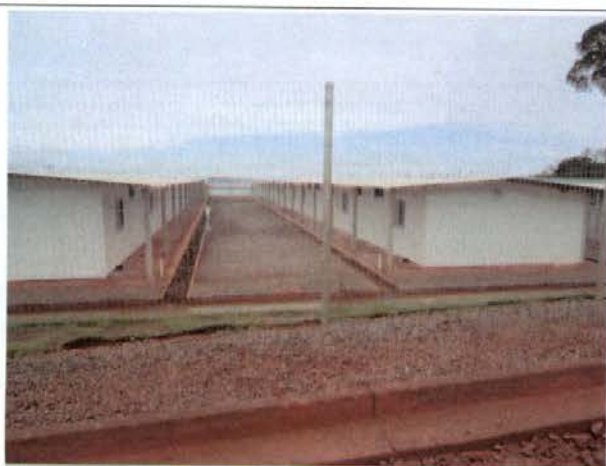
Acampamento definitivo em implantação no sítio construtivo Belo Monte.
